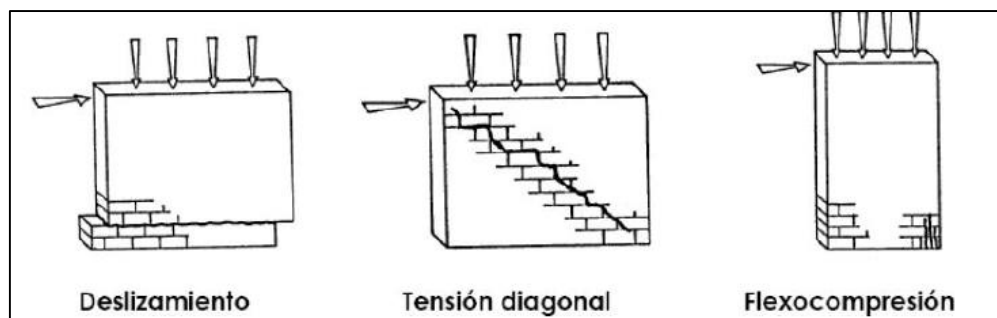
Posibles modos de falla en un muro de mampostería. Tomado de (Zalamea, 2015)
